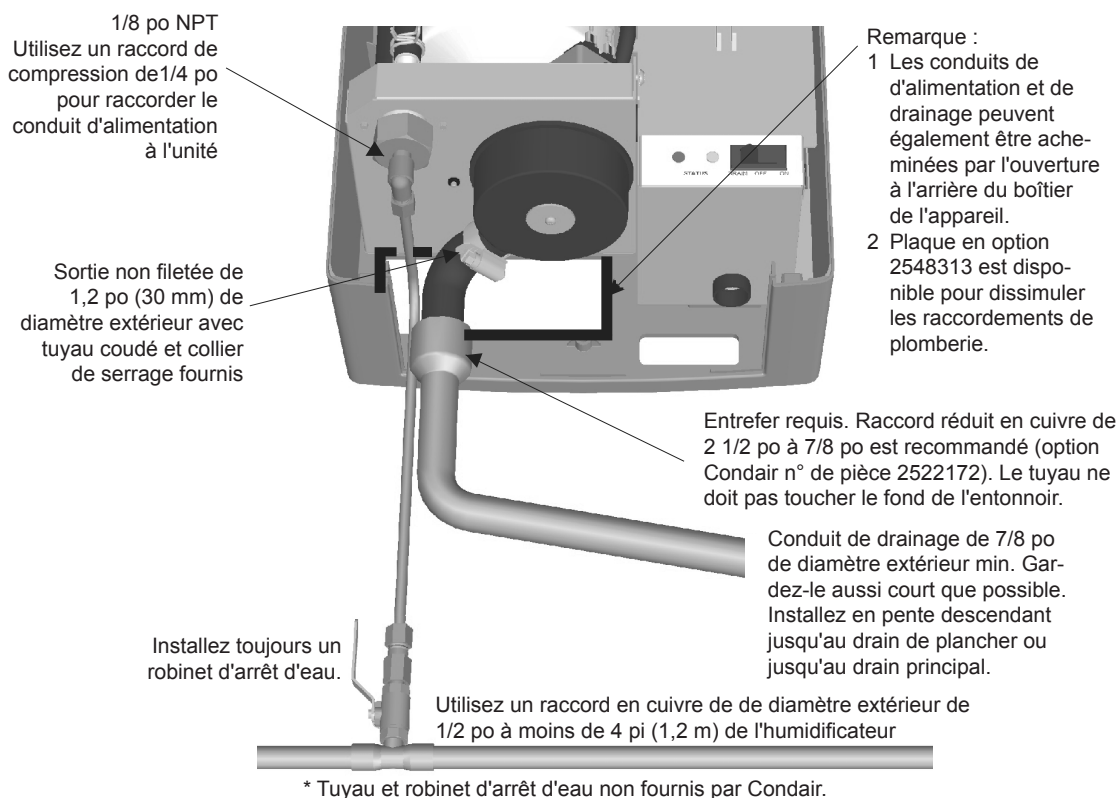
Raccordement de la conduite d'alimentation en eau et du drain
